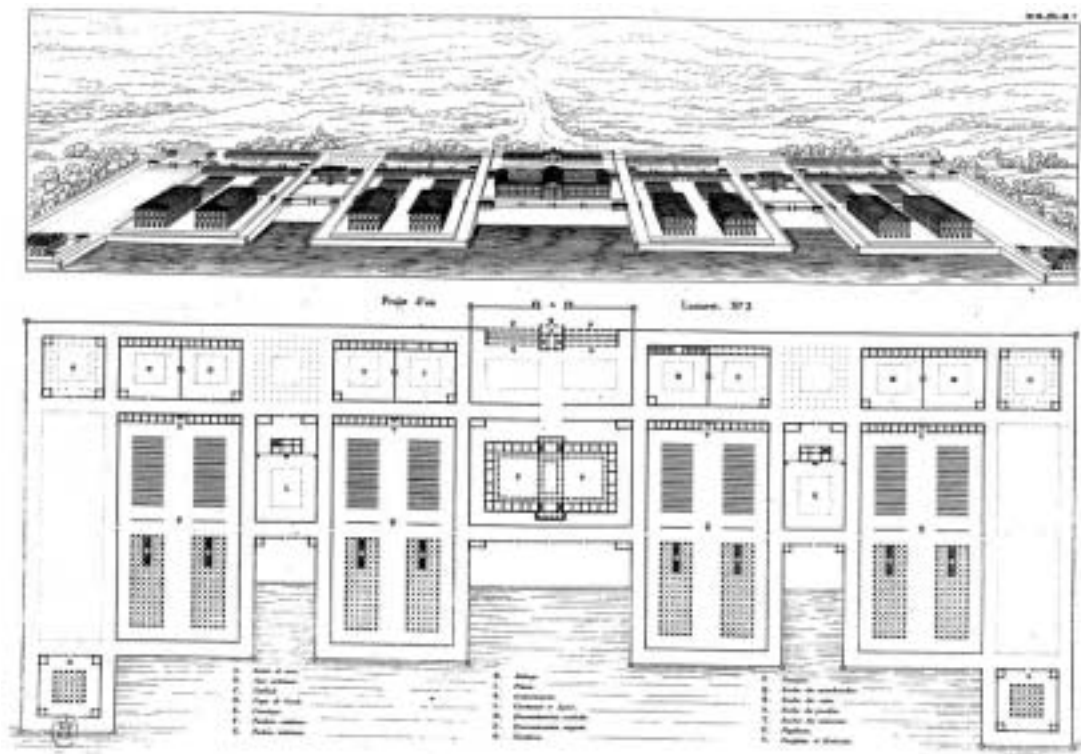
Projet d'un lazareth n° 2*, planta. En Bruyère, Louis. *Esquisse d'une petite ville...* Paris: chez Bance aîné, 1823, plancha 10
